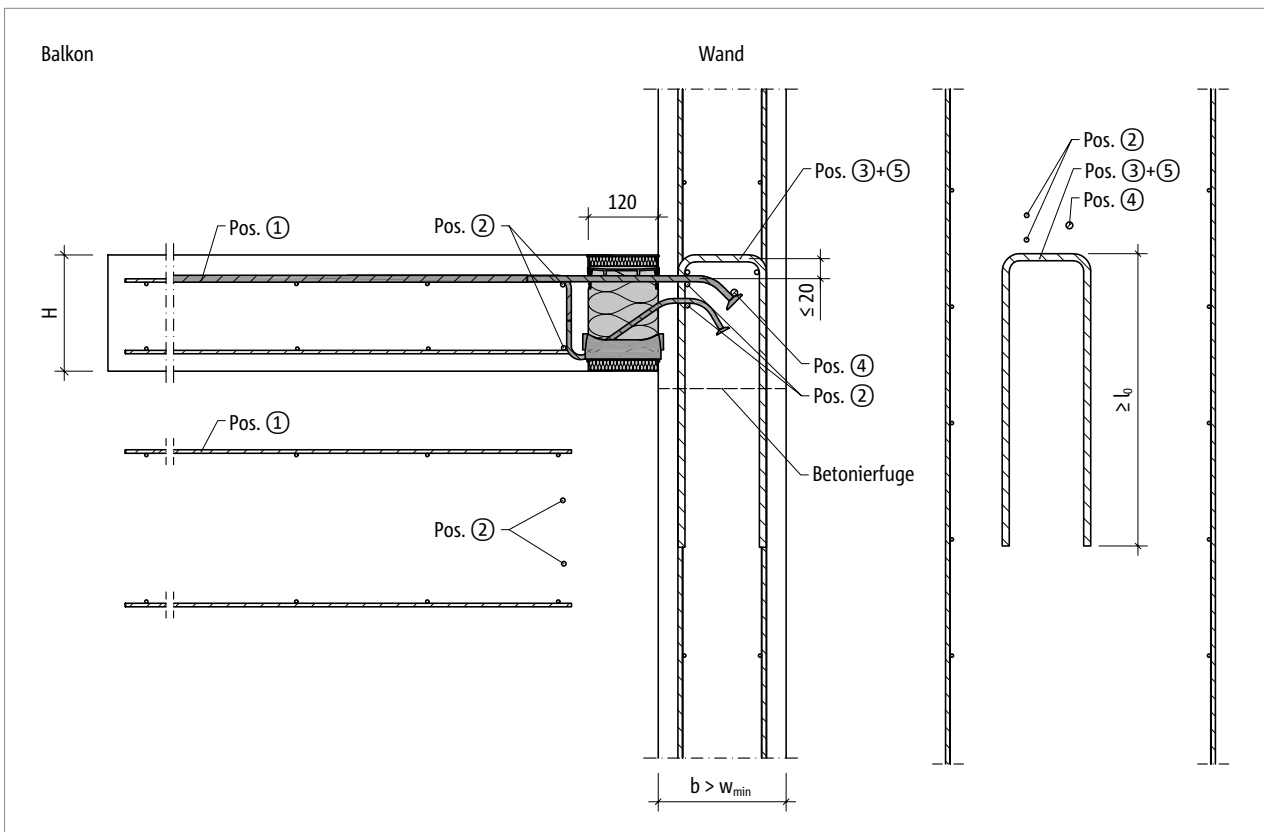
Schöck Isokorb® XT Typ KL-O: Bauseitige Bewehrung für Wandanschluss mit größerer Bauteilabmessung ( $w_{vorh} > w_{min}$ )
